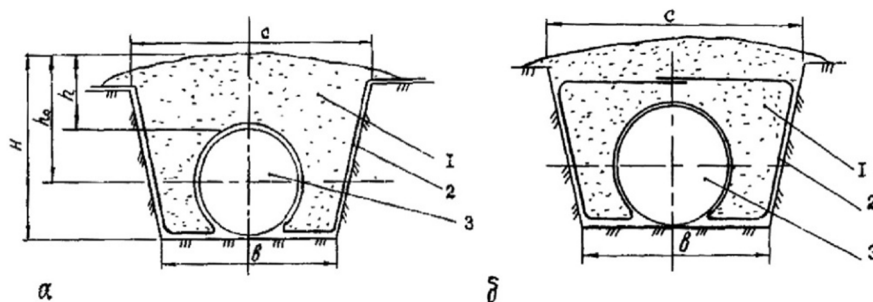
Схемы балластировки трубопроводов грунтом с применением НСМ:
